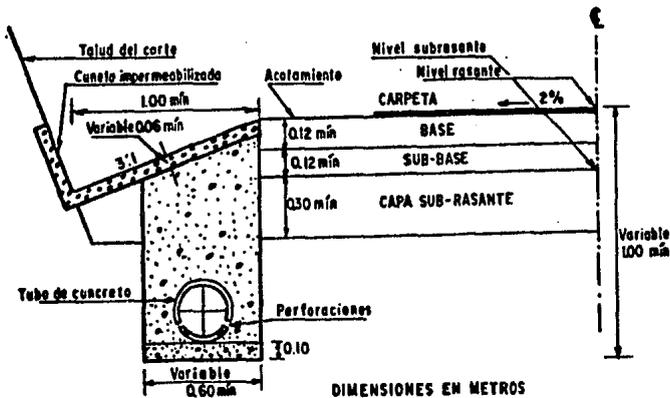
Sección transversal de un subdren longitudinal de zanja.
